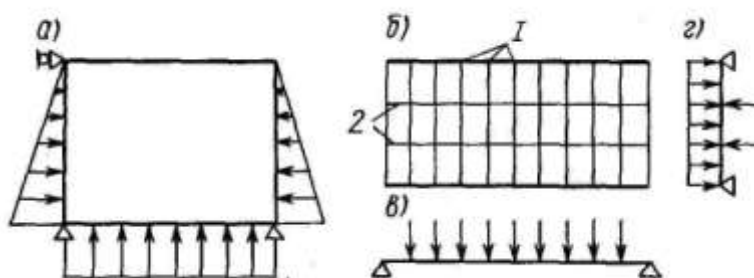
Рама и перекрытие: а - схема нагрузки на раму; б - схема перекрытия; в, г - схема нагрузок на балки главного направления и перекрестные связи. 1 - балки главного направления; 2 - перекрестные связи
